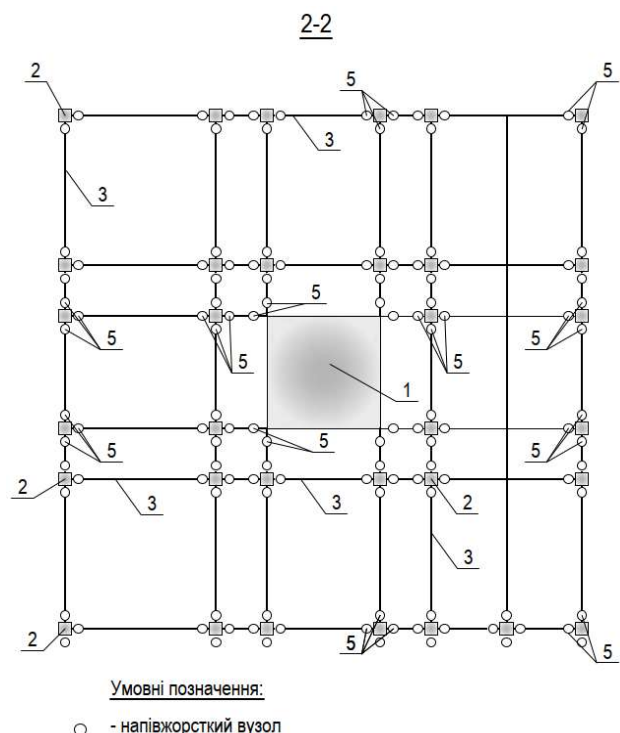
Переріз 2-2 – план-схема секції з напівжорстким з'єднанням балок та дисків перекриття зі стовбуром та колонами
